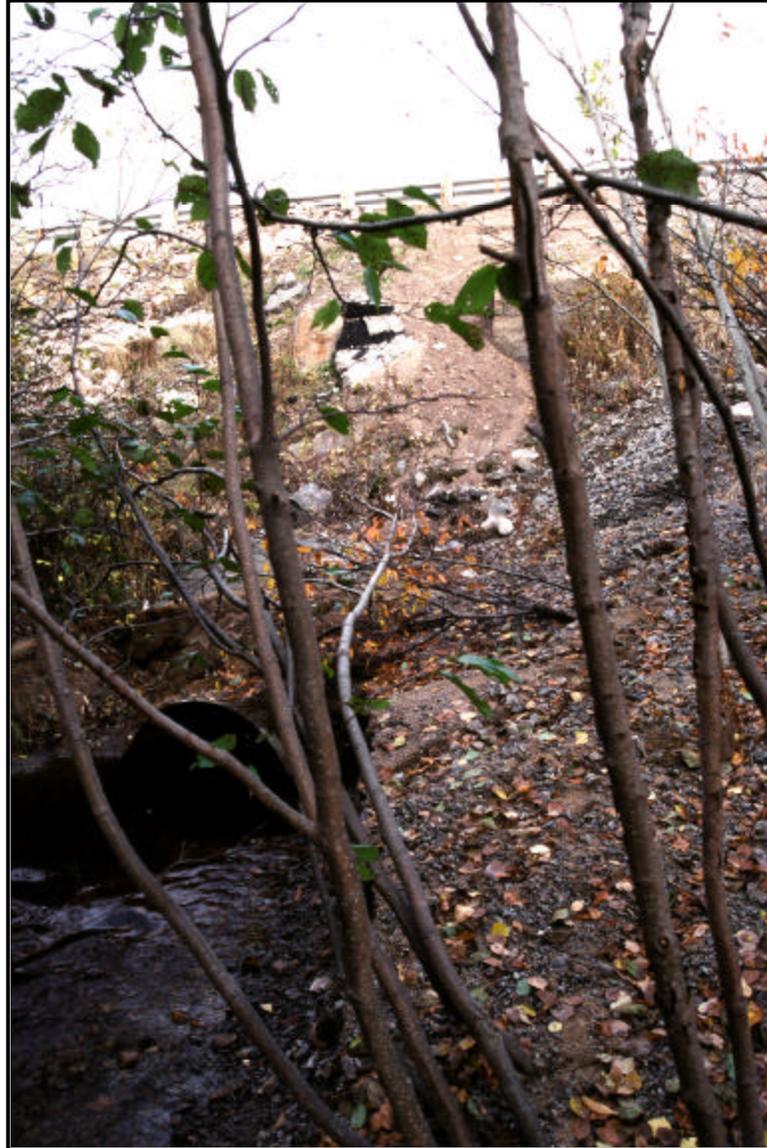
Sortie du ponceau et talus sud, remblai de la route 138, en direction nord, ponceau à l'est de la rivière Blanche (20-3574-0557-D3-13)
